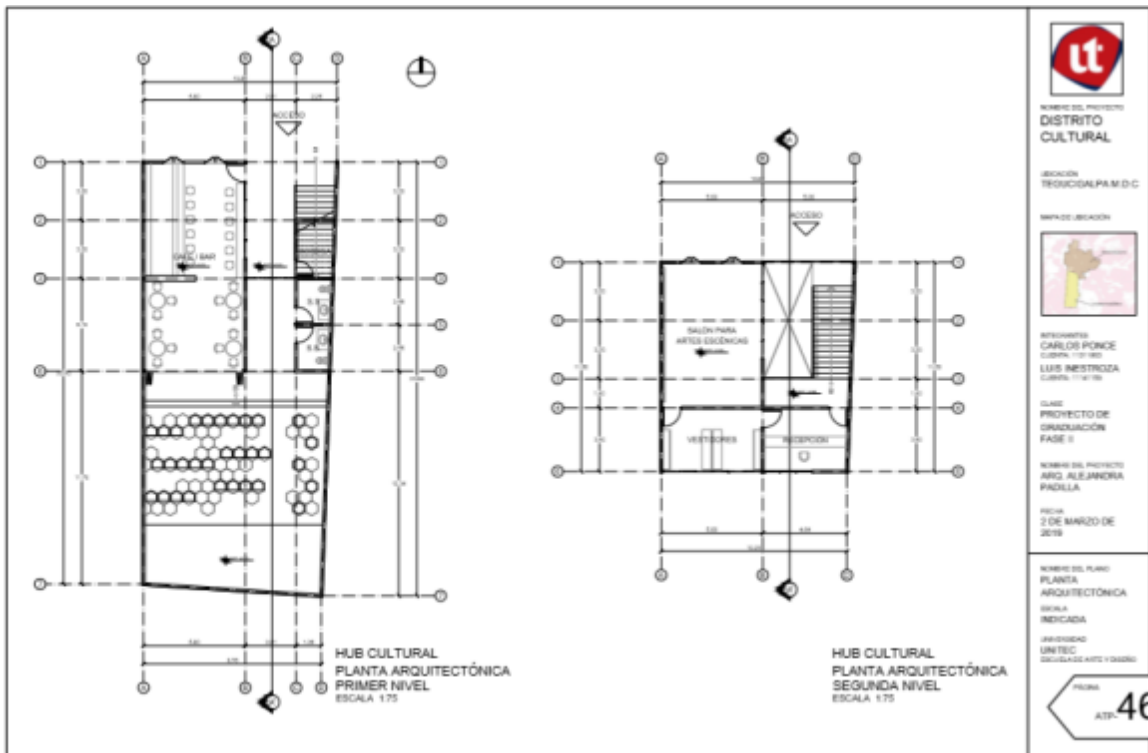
Plantas Arquitectónicas Hub Cultural
